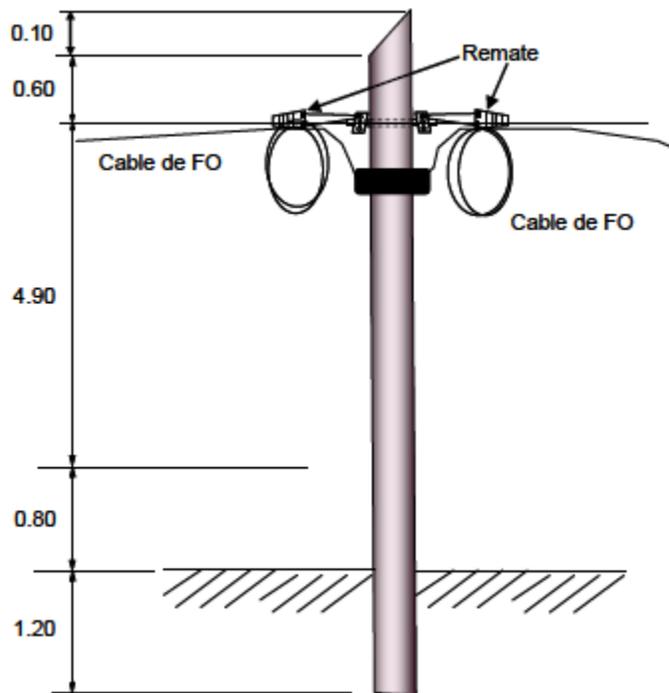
Colocación y Fijación de la Gaza en Poste.
